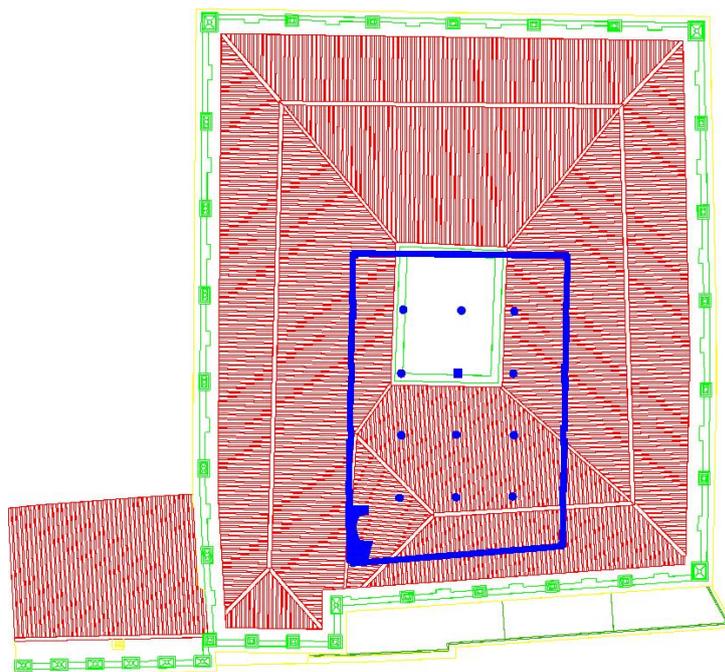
Planta del aljibe (azul) y tejados actuales (rojo)<sup>10</sup>
